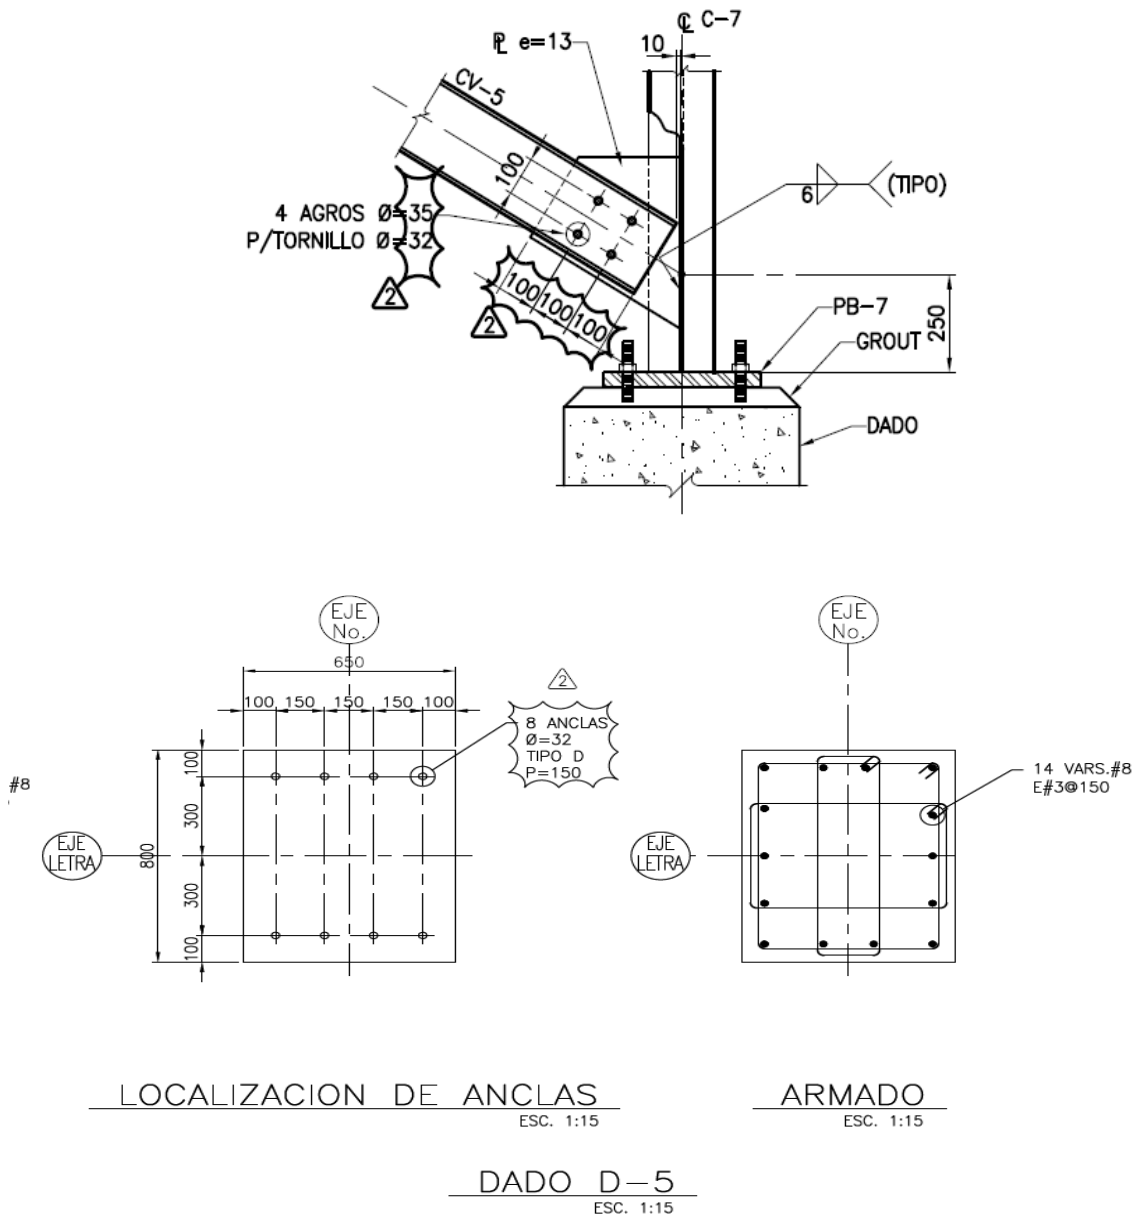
Habilitado de refuerzo en traves de liga y dados para la cimentación de un Rack
